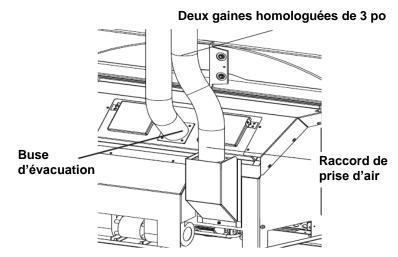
Emplacement des raccords du conduit d'évacuation et de la prise d'air.
